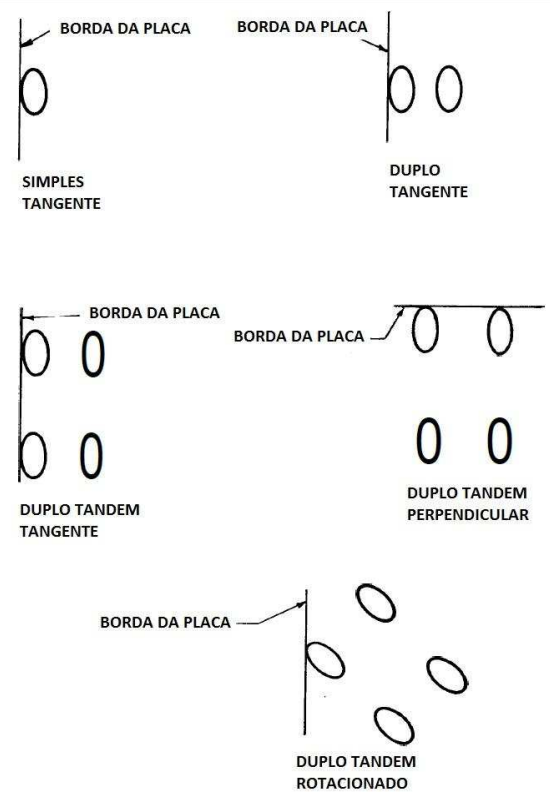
Posições de montagem para análise de pavimentos rígidos (Adaptado - FAA, 1995).
